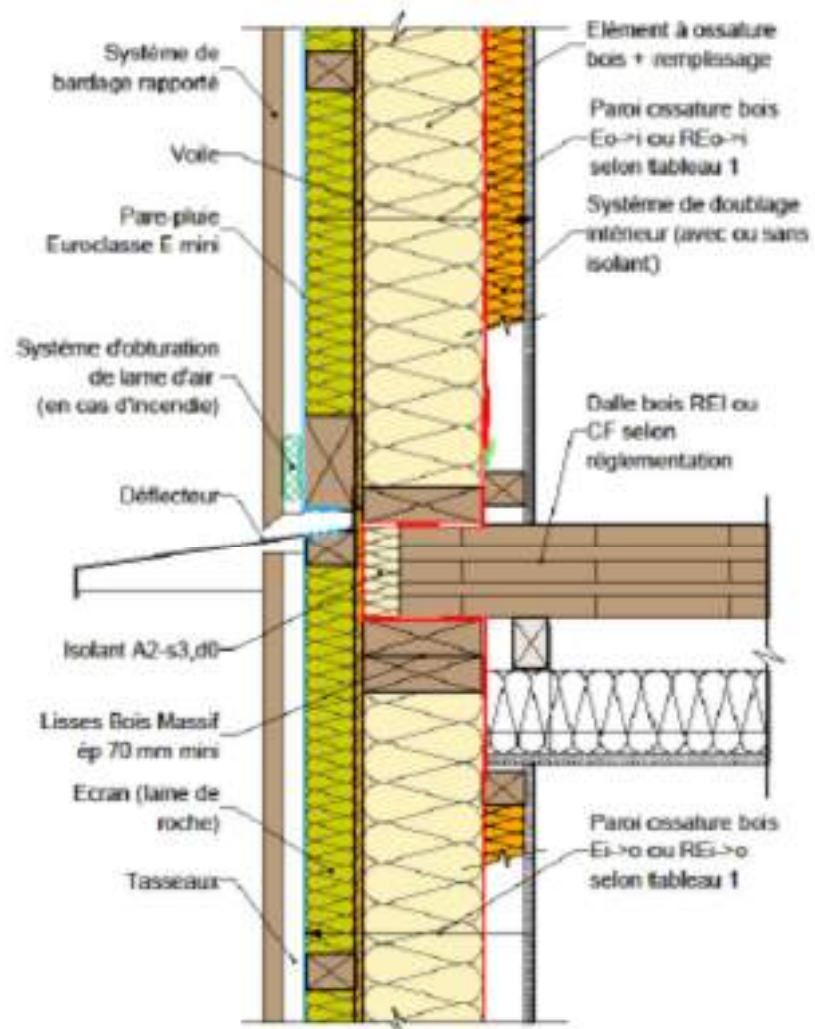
Façade/mur ossature bois & plancher en panneau bois massif.
